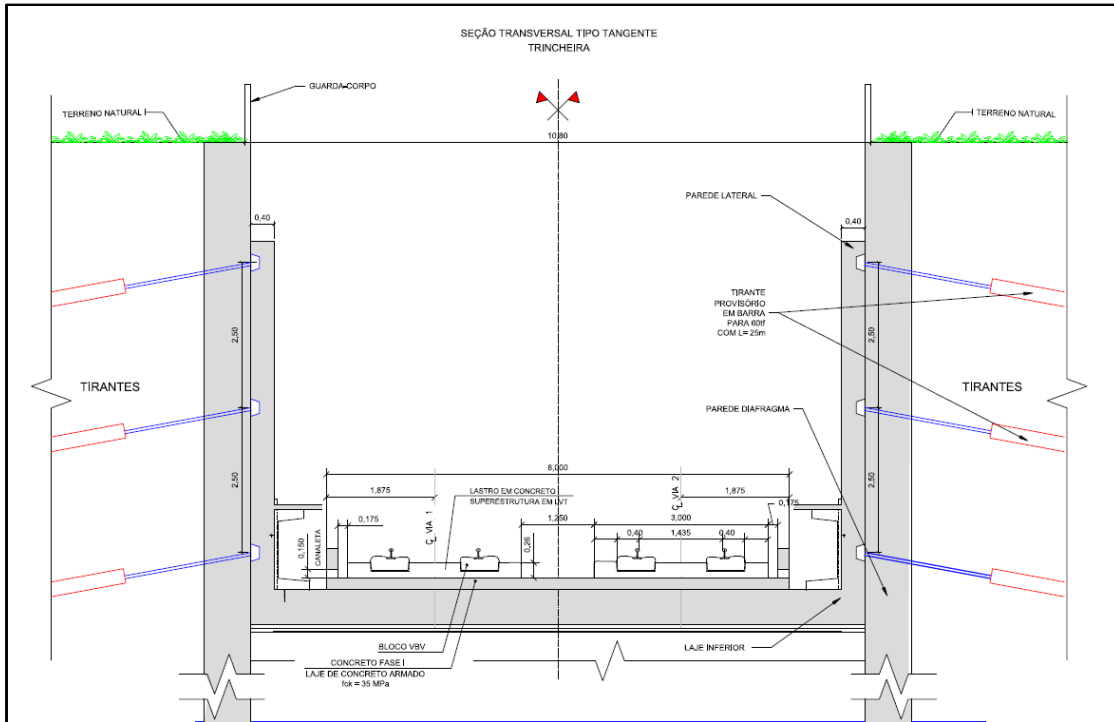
Seção transversal tipo – Detalhe Trecho em Trincheira Aberta Superestrutura LVT
